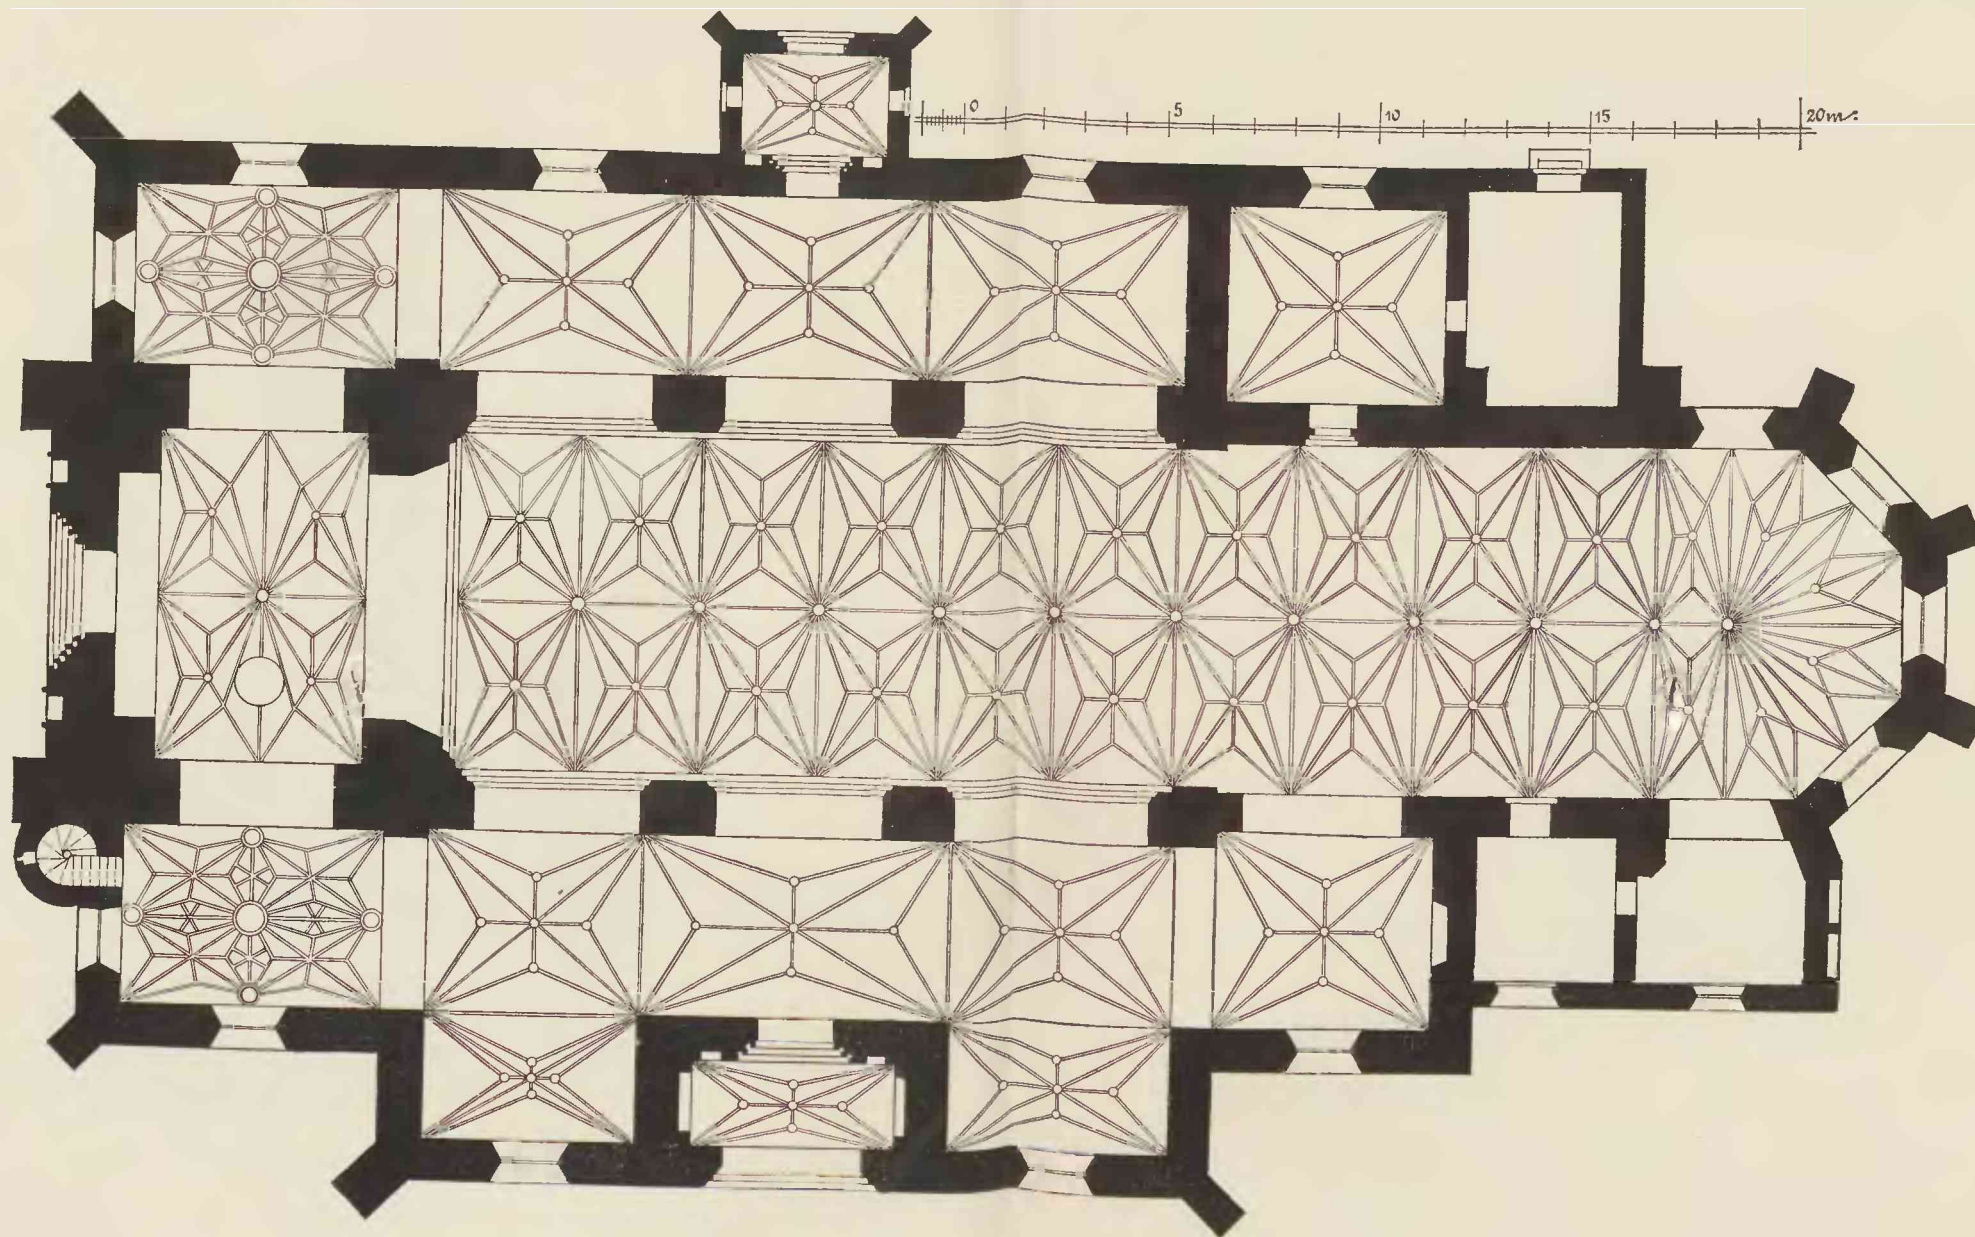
Grundriß der Pfarrkirche zu Bartenstein.
